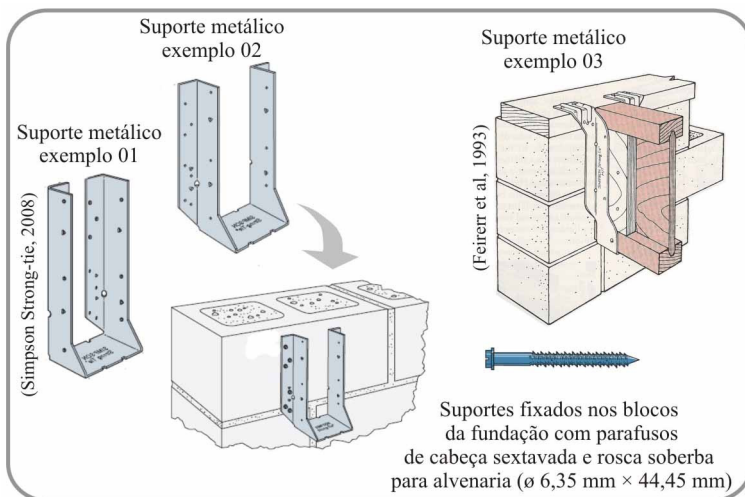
Exemplos de suportes metálicos para fixação das vigas
